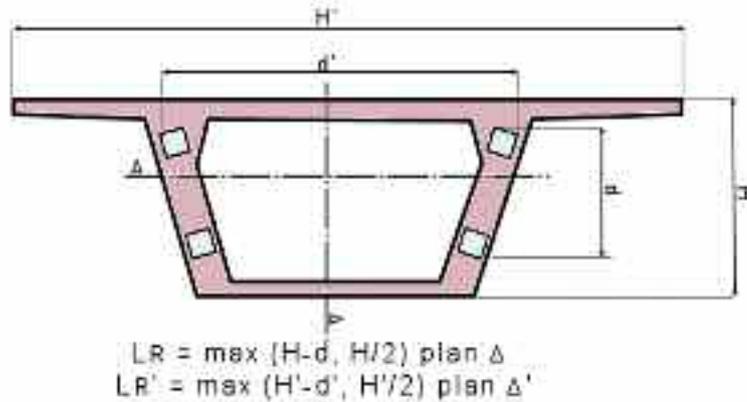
longueur de régularisation conventionnelle dans le cas d'une poutre-caisson
